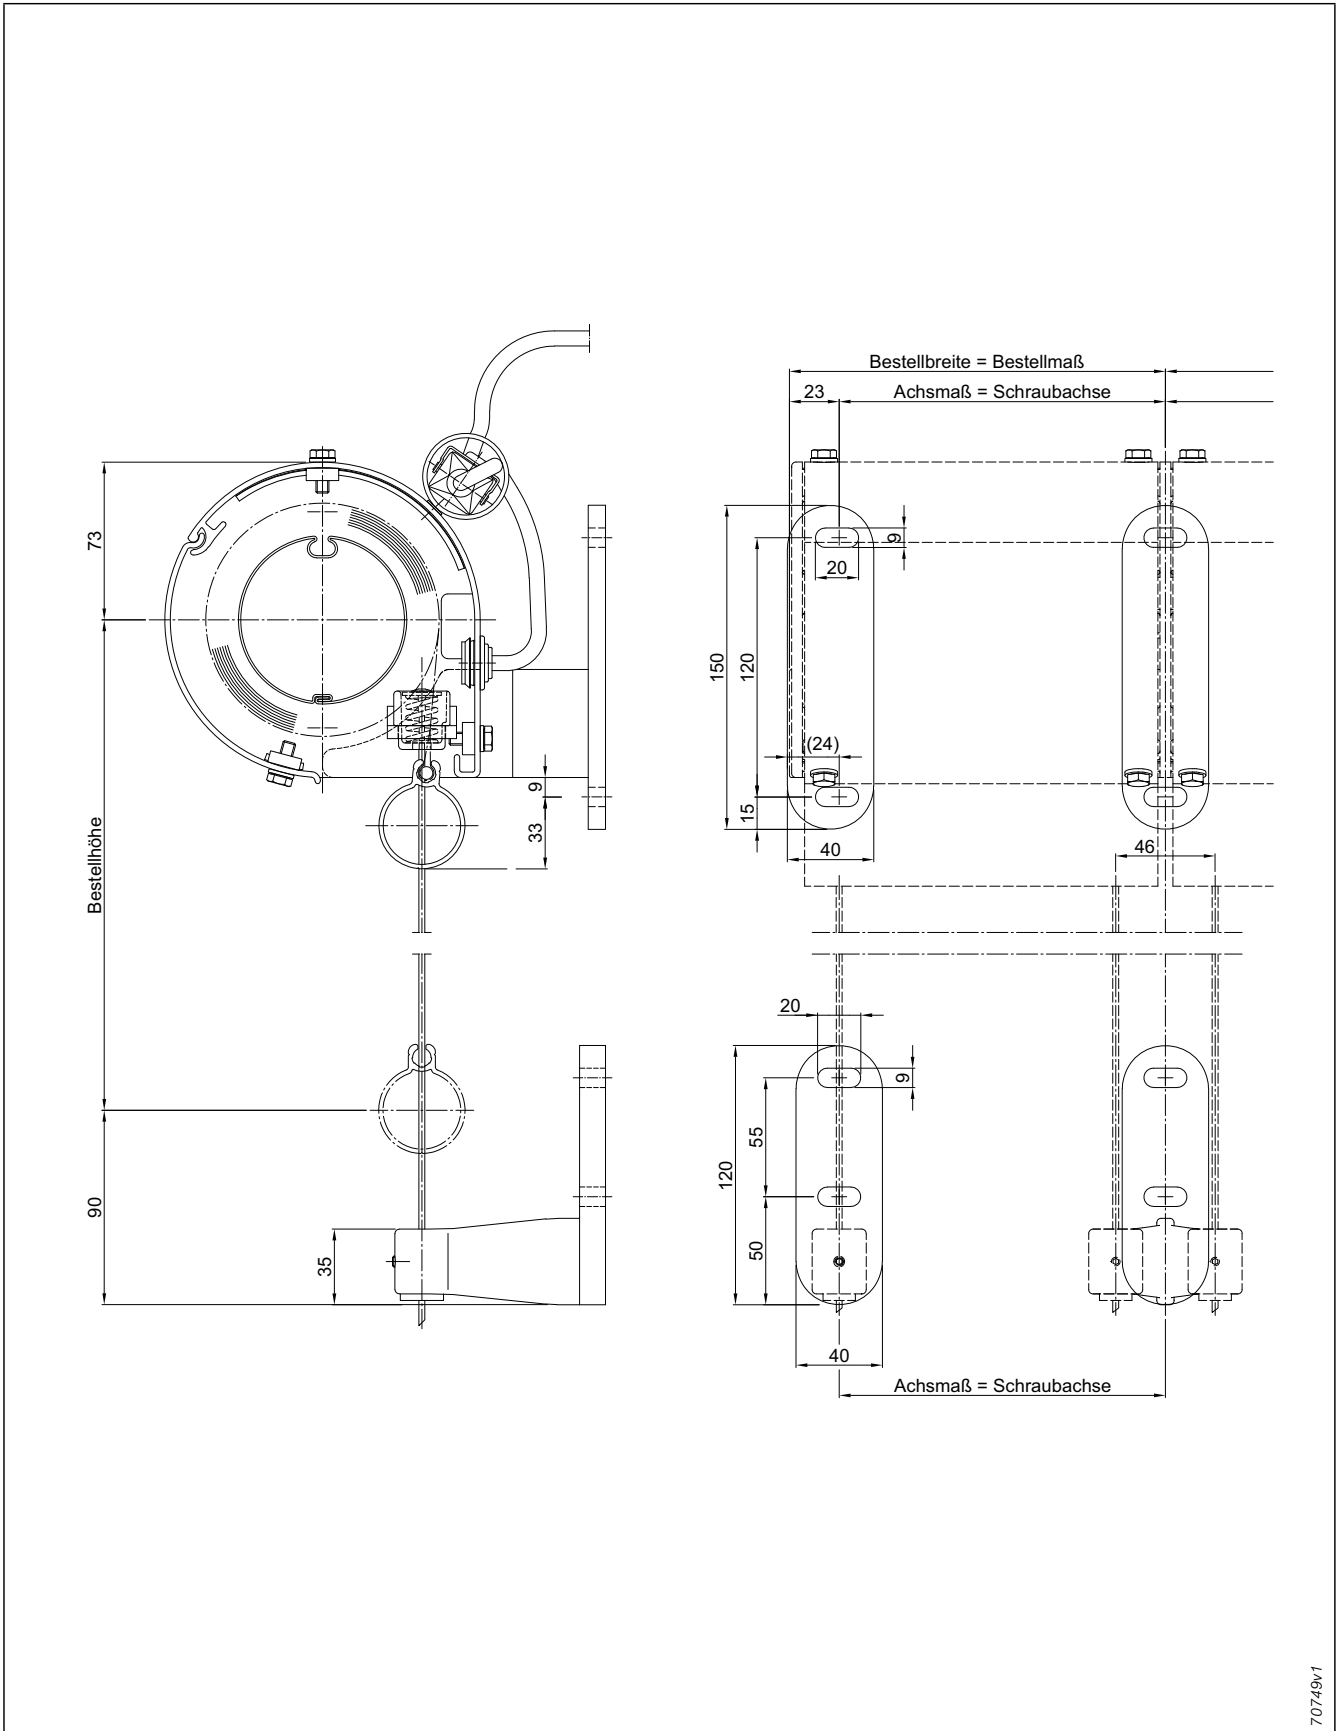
Fassaden-Markise 207 mit Rundblende Typ 8.3, Befestigungsmaße Einzelanlage
